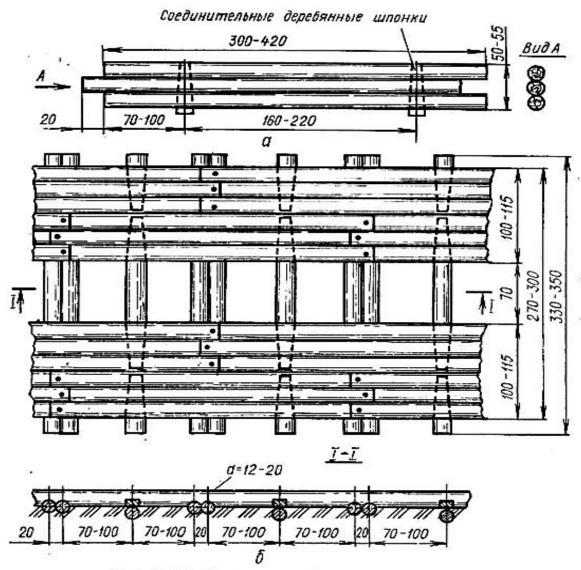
Покрытие из бревенчатых щитов: a — бревенчатый щит; b — план и разрез покрытия
